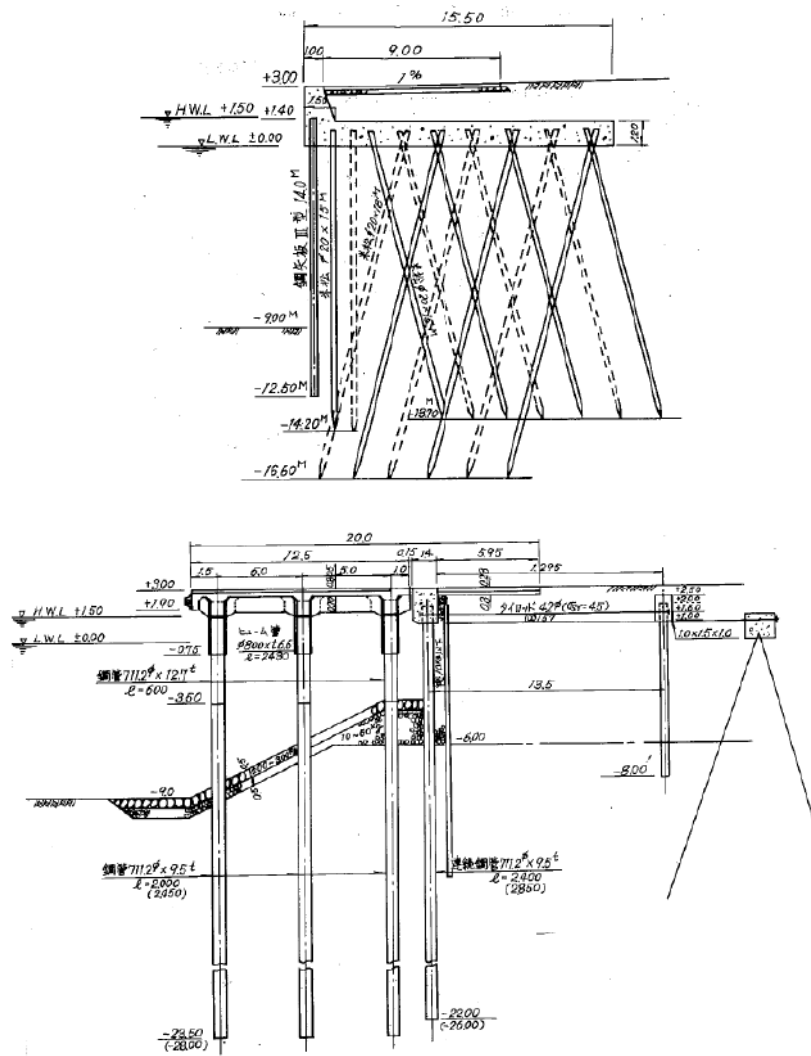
茶屋前地区岸壁 (-9m) の標準断面図
